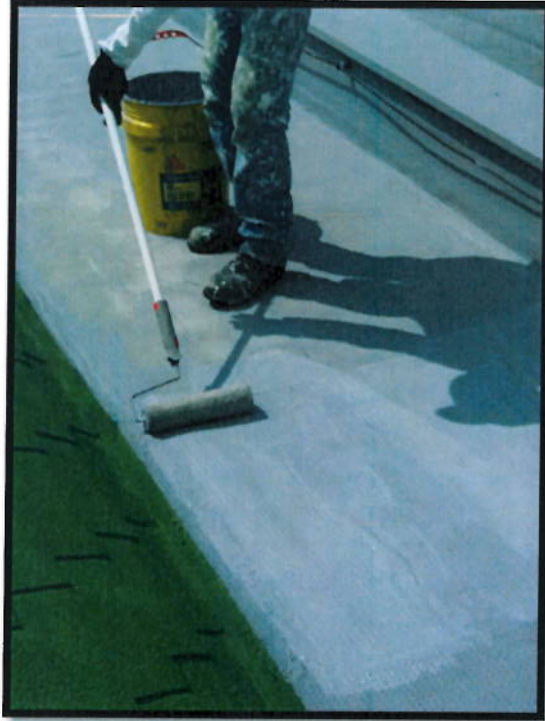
APLICACIÓN SIKAFILL EN CUBIERTA
